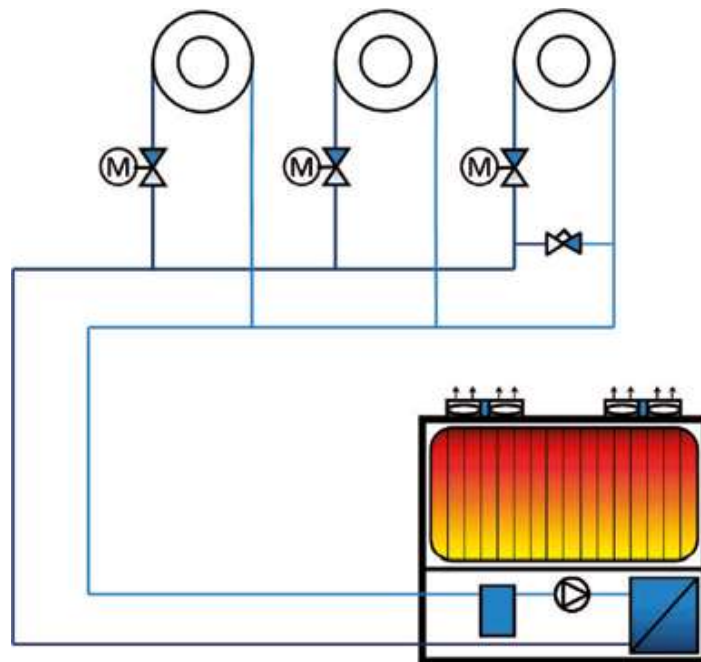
Hydraulische Einbindung luftgekühlter Kompaktkaltwassersatz für Außenaufstellung mit Zweibege-Drosselventil am Verbraucher
